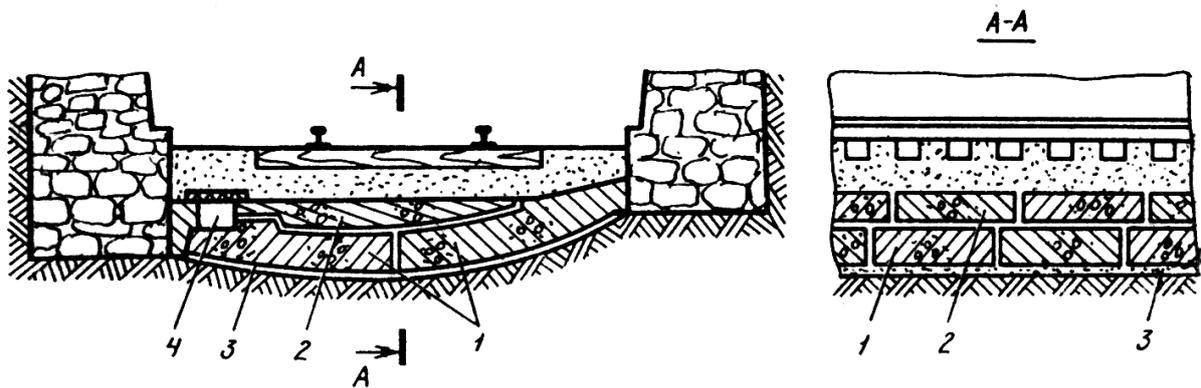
Сборная обделка обратного свода: 1 – блоки типа I; 2 – блоки типа II; 3 – щебеночная подготовка; 4 – водоотводный лоток
